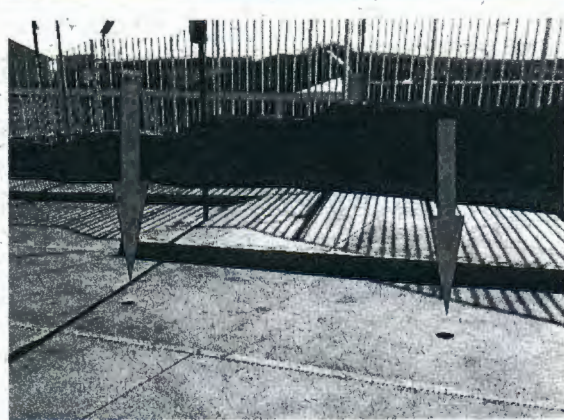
Fisuras en el muro de hormigón del cierre perimetral.
